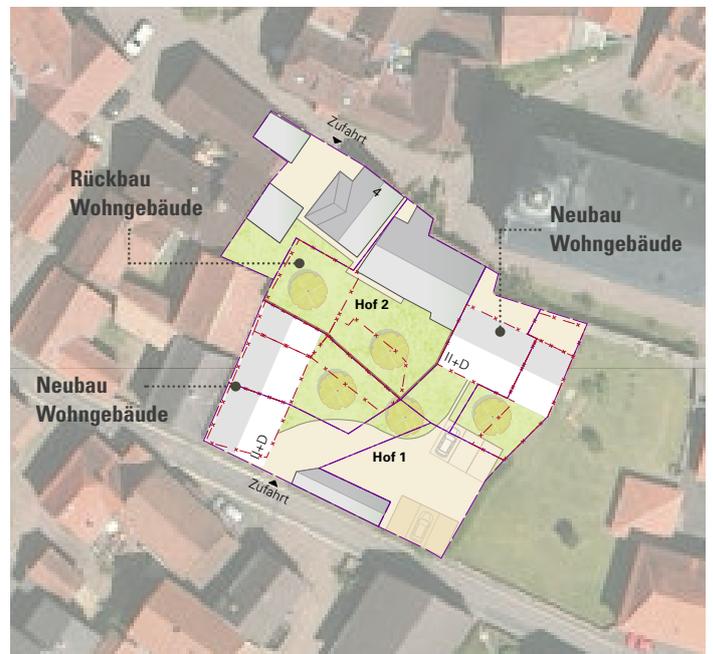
Lageplan - Weiterentwicklung der Hofstruktur 6 (Variante 2)
